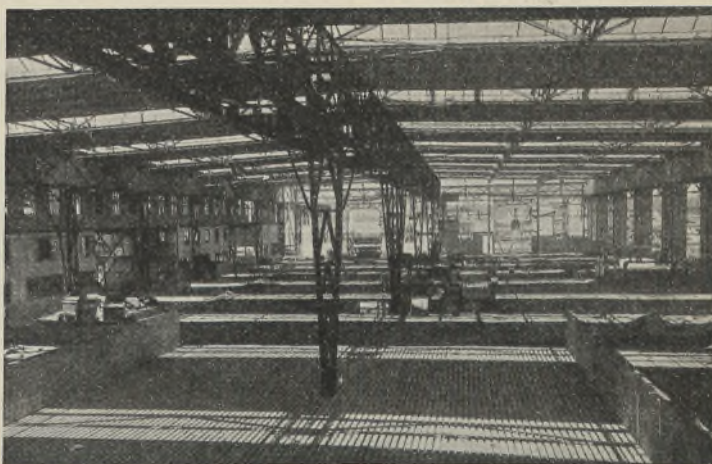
Arbeitshallen der Deutschen Werft in Hamburg-Finkenwärder. (Ausführung Breest & Co., Berlin.)
